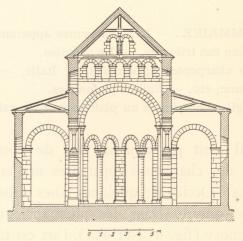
Eglise de Vignory. Plan. Fig. 955. — Eglise de Vignory. Coupe transversale.
